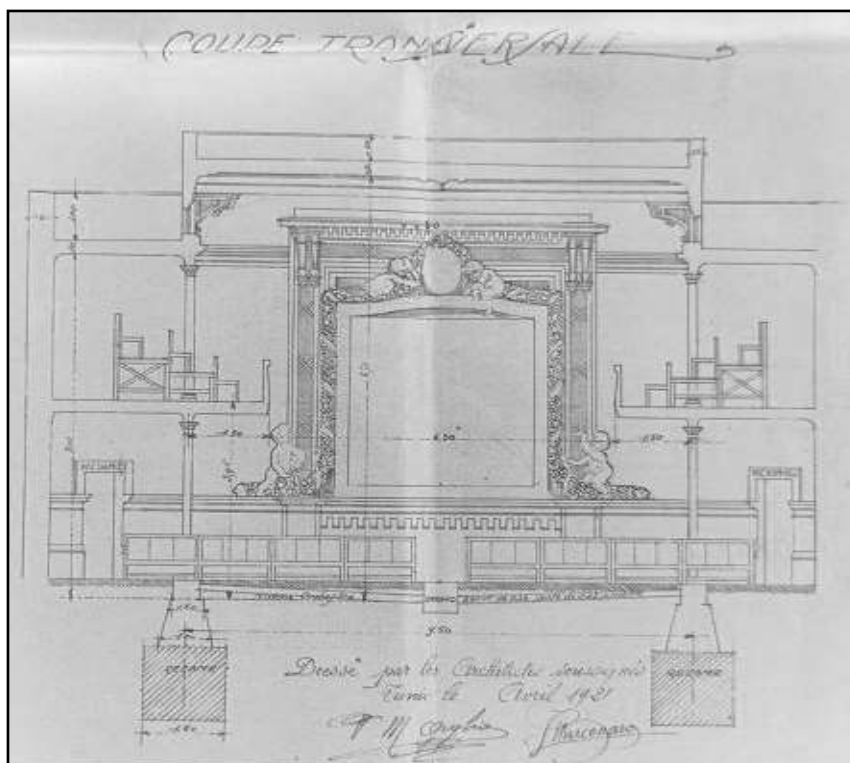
Coupe transversale de la salle : elle montre l'écran, les niveaux de la salle de projection, les fondations et la disposition des sièges. Source : Les archives de la municipalité de Tunis.
